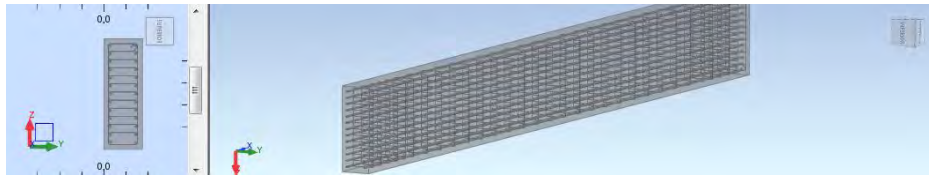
DETALLE DE ARMADURA DE LA VIGA
